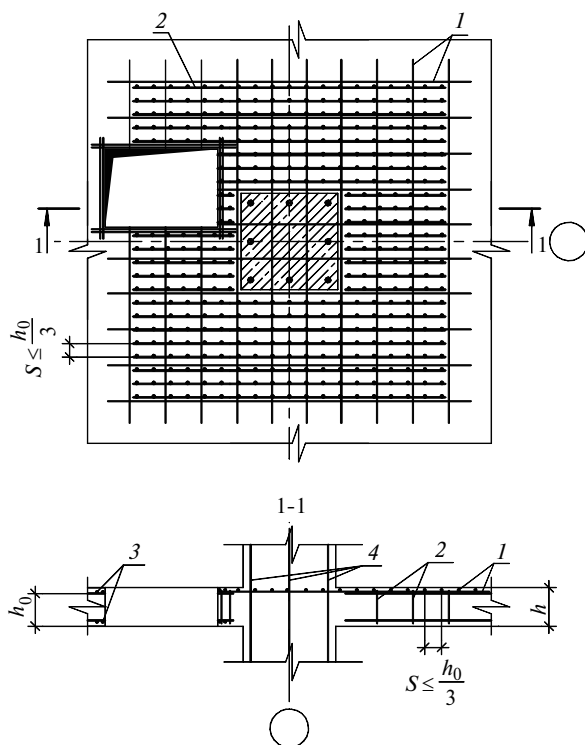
Схема расположения рабочей арматуры в опорной зоне плоской плиты перекрытия:
